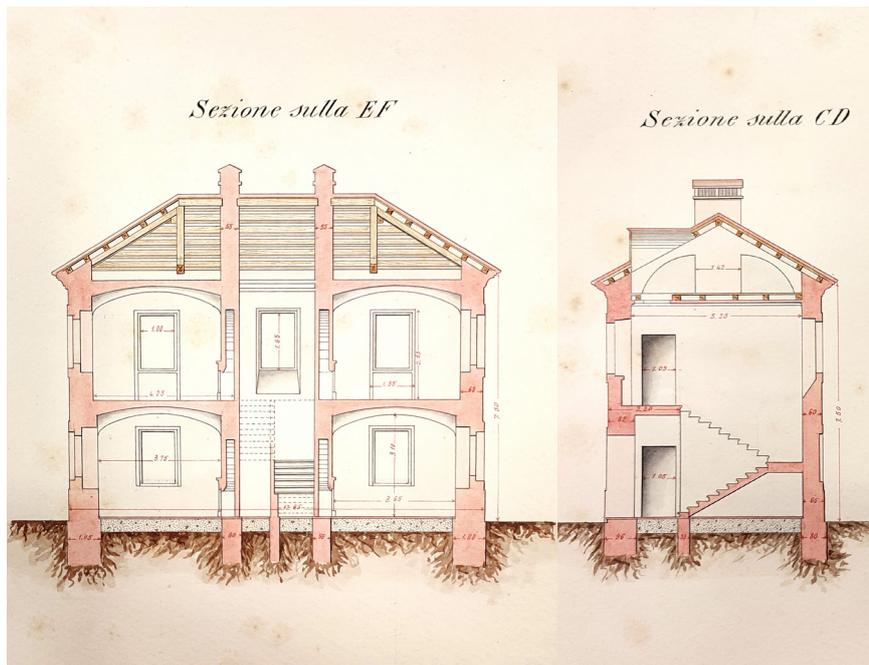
e 5 - Sezione E-F e sezione C-D del Casello Tipo.
